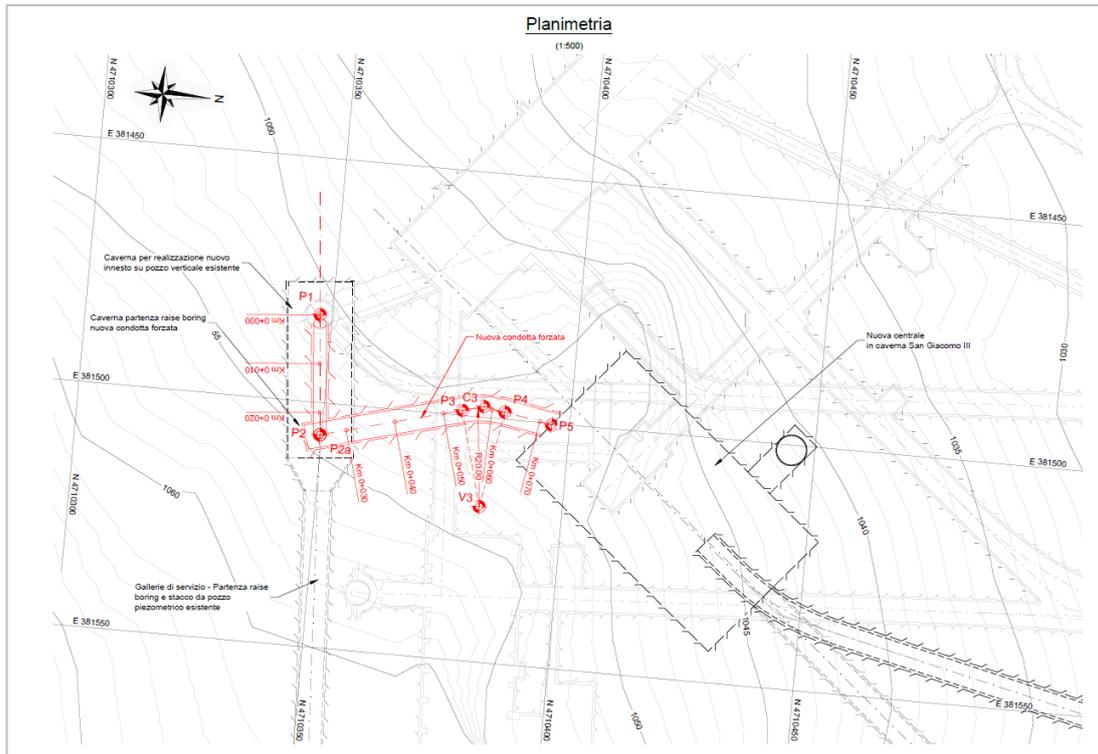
Nuova connessione al pozzo forzato esistente di San Giacomo II – pianta
